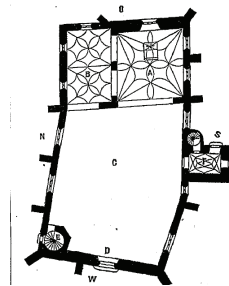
Grundriss St. Nikolaus Altenberg vor 1876 von Hugo Altendorff aus Deutsche Bauzeitung 1878
